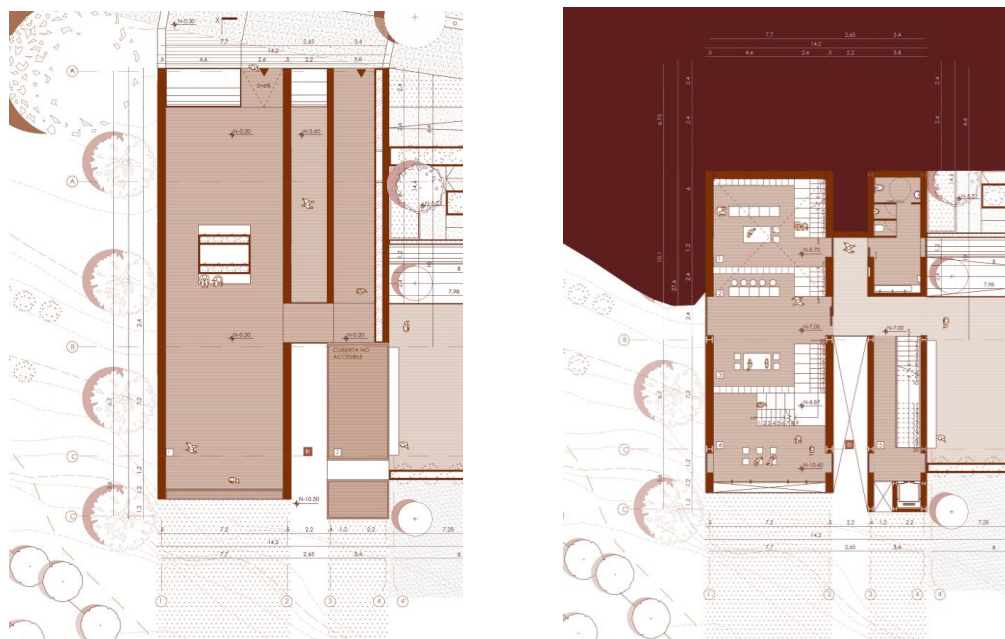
Bloque I. Planta de cubierta N-0.20 y Planta N-7.00
